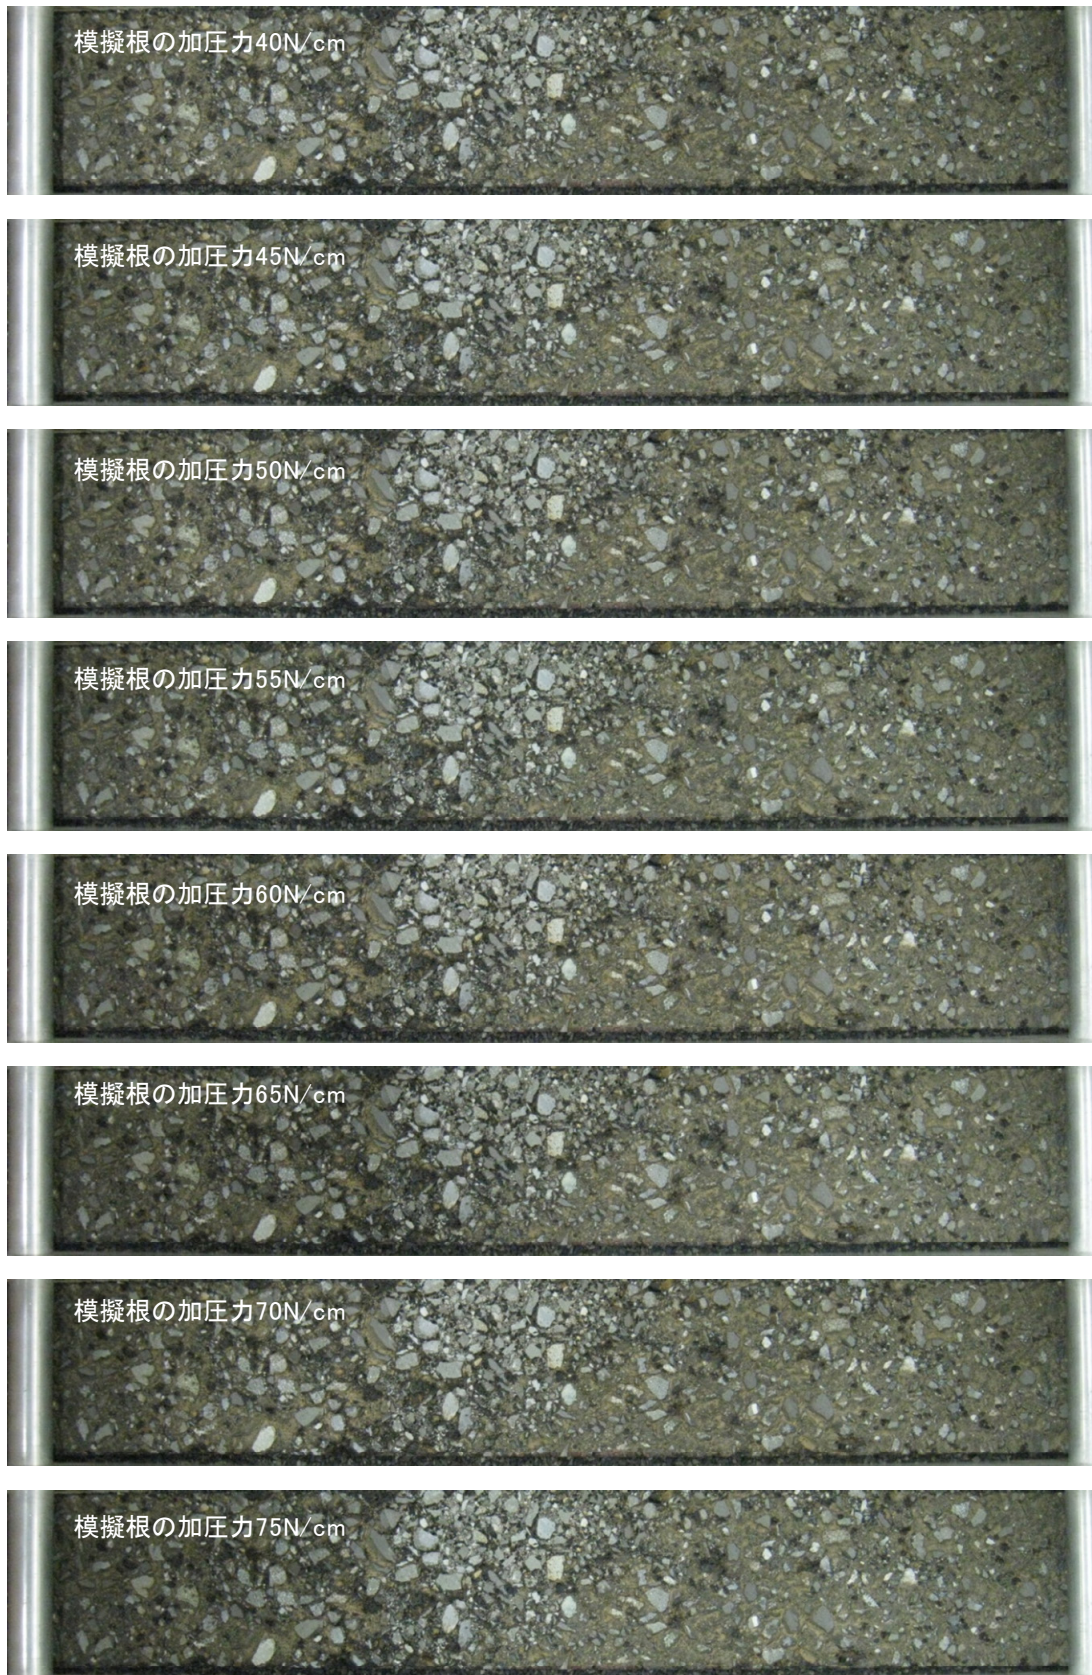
アスファルト舗装表面のひび割れ状態の一例(模擬根直上の砂層の厚さ20mm) 2/3
